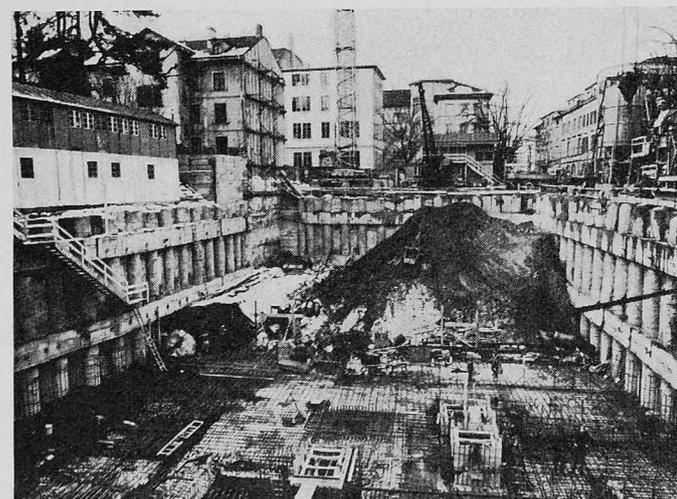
Tiefbahn Wien: Tunnel mit seitlichen Schlitzwänden
